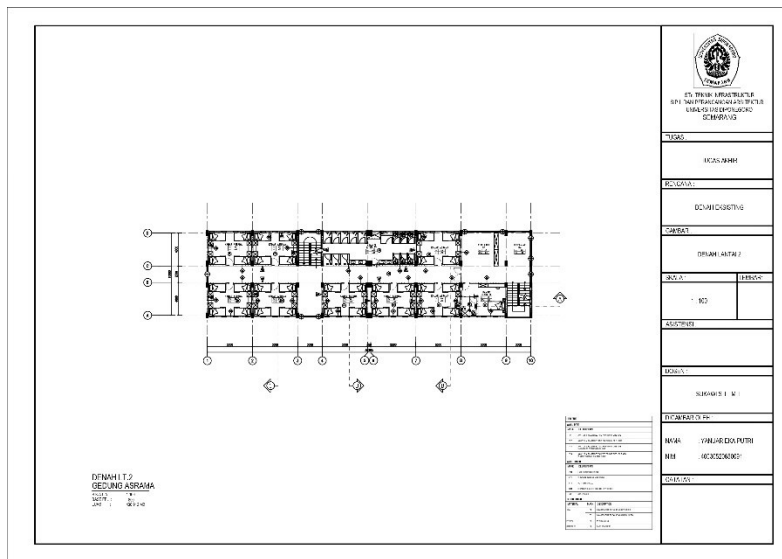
Gambar Arsitektural Tampak Eksisting Bangunan:
